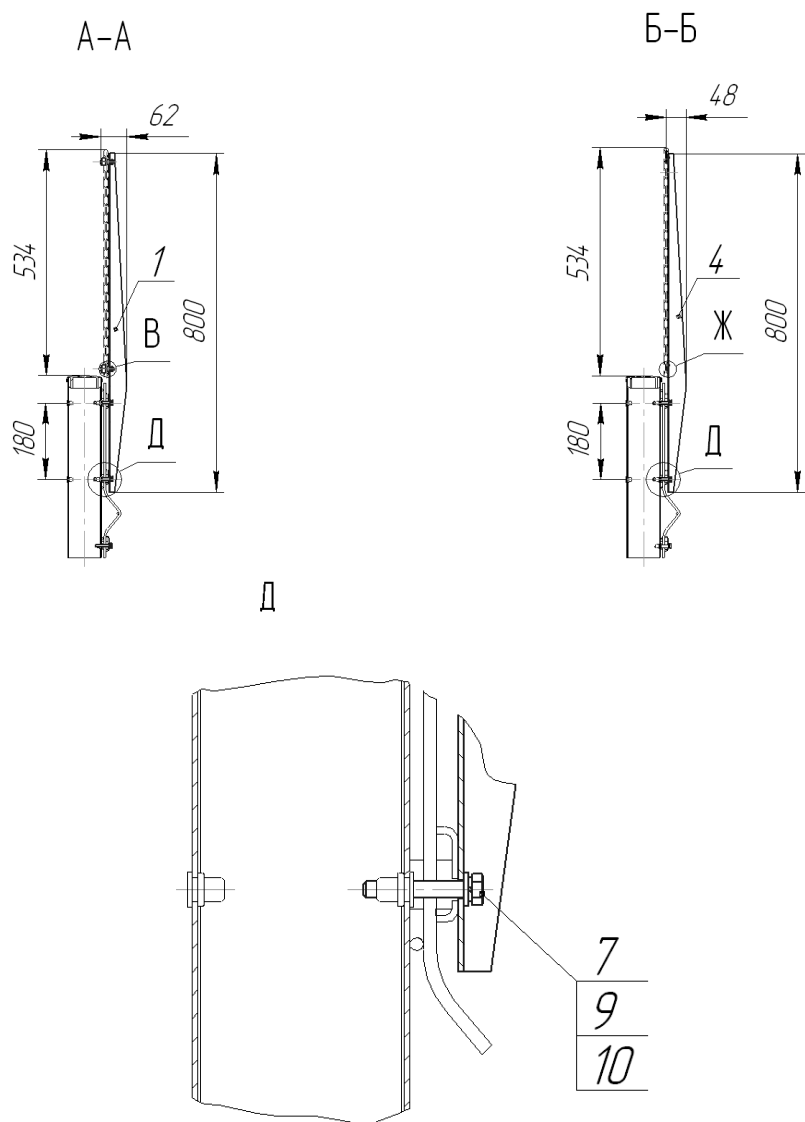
Разрезы А-А, Б-Б, детальный вид Д
